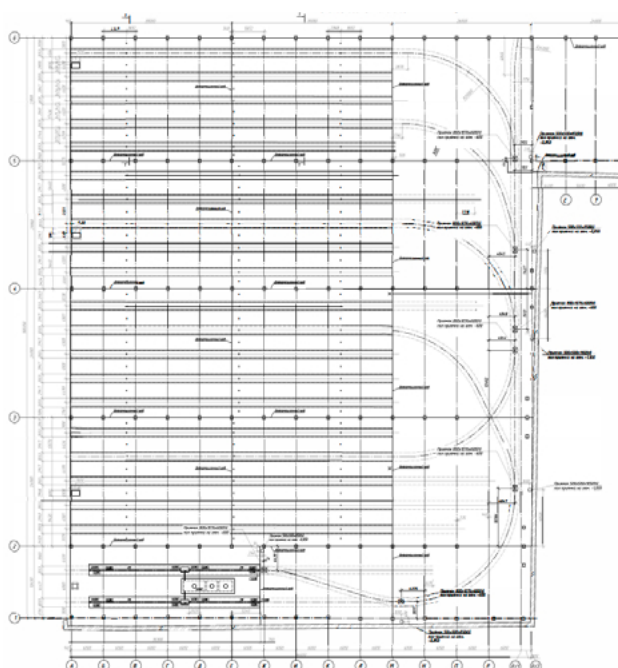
Фрагмент плана основания здания депо на отметке 0.00.
